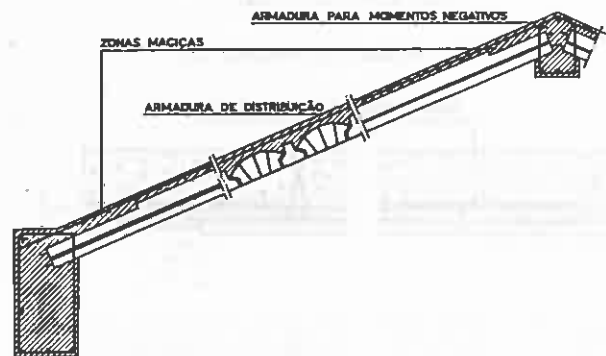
Cobertura com laje aligeirada e telha assente sobre esta
